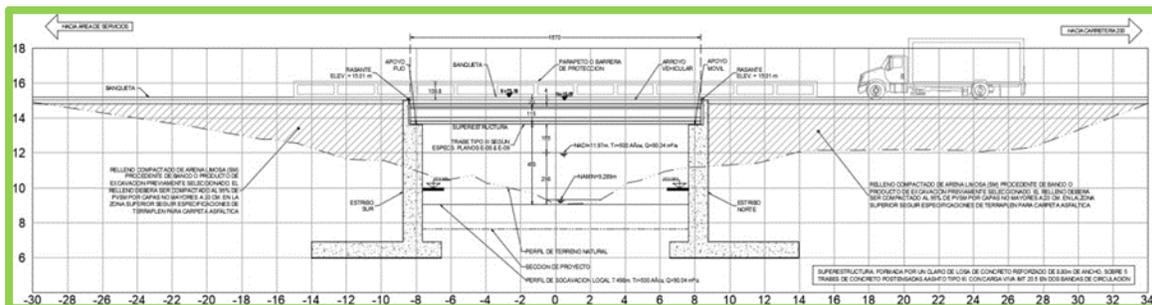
Sección longitudinal de puente vehicular. S/E
